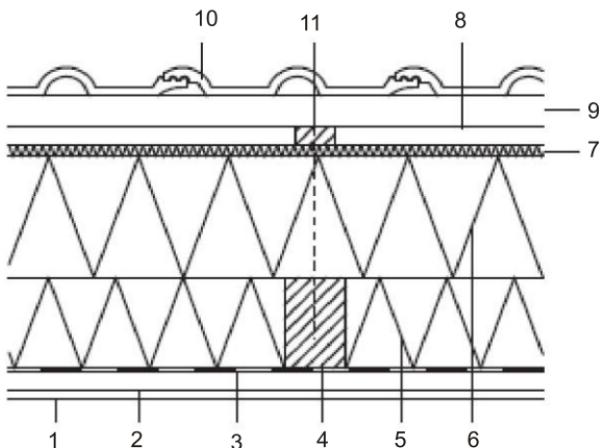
Полная теплоизоляция поверх стропил с помощью теплоизоляционных древесно-волокнистых плит: 1 — облицовка из гипсокартона; 2 — обрешетка/установочная поверхность; 3 — пароизоляционная прокладка; 4 — имеющиеся стропила; 5 — теплоизоляционный слой; 6 — теплоизоляционные древесно-волокнистые плиты, например, Gutex; 7 — диффузионно-проницаемые плиты для обшивки стен и крыш (DWD-Platte, diffusionsoffene Wand- und Dachplatte); 8 — противовесная обрешетка; 9 — обрешетка крыши; 10 — кровельное покрытие; 11 — крепление древесно-волокнистой плиты, например, шуруп по дереву
